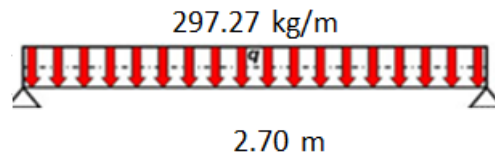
Carga distribuida en la viga eje 3 entre a-b y b-c
